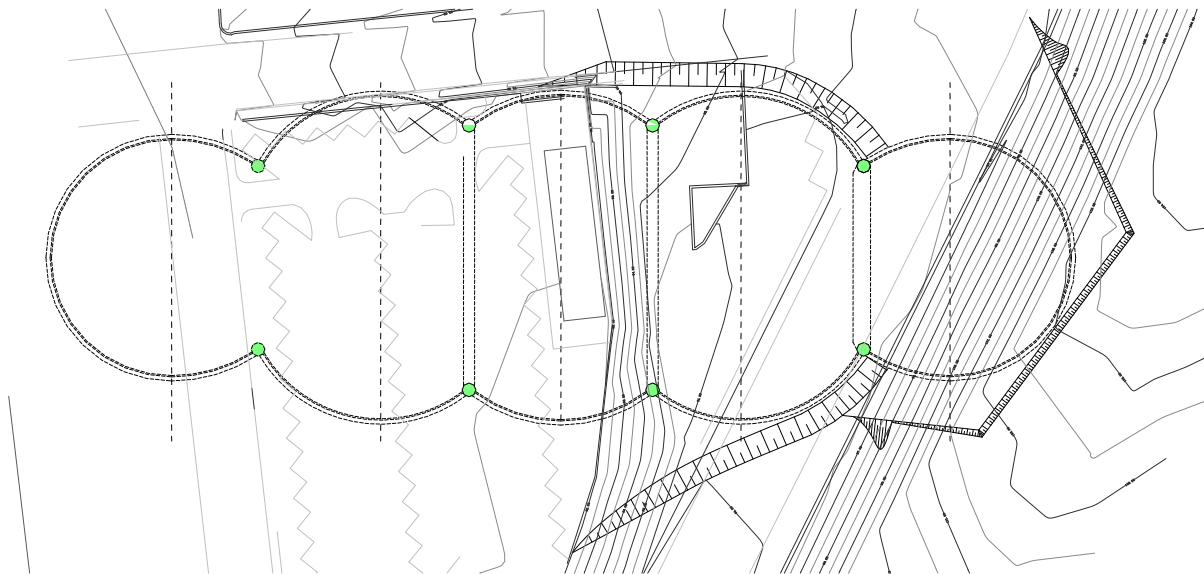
Planta das estacas pilares e muros de contenção (Adaptado CJC, 2009).
